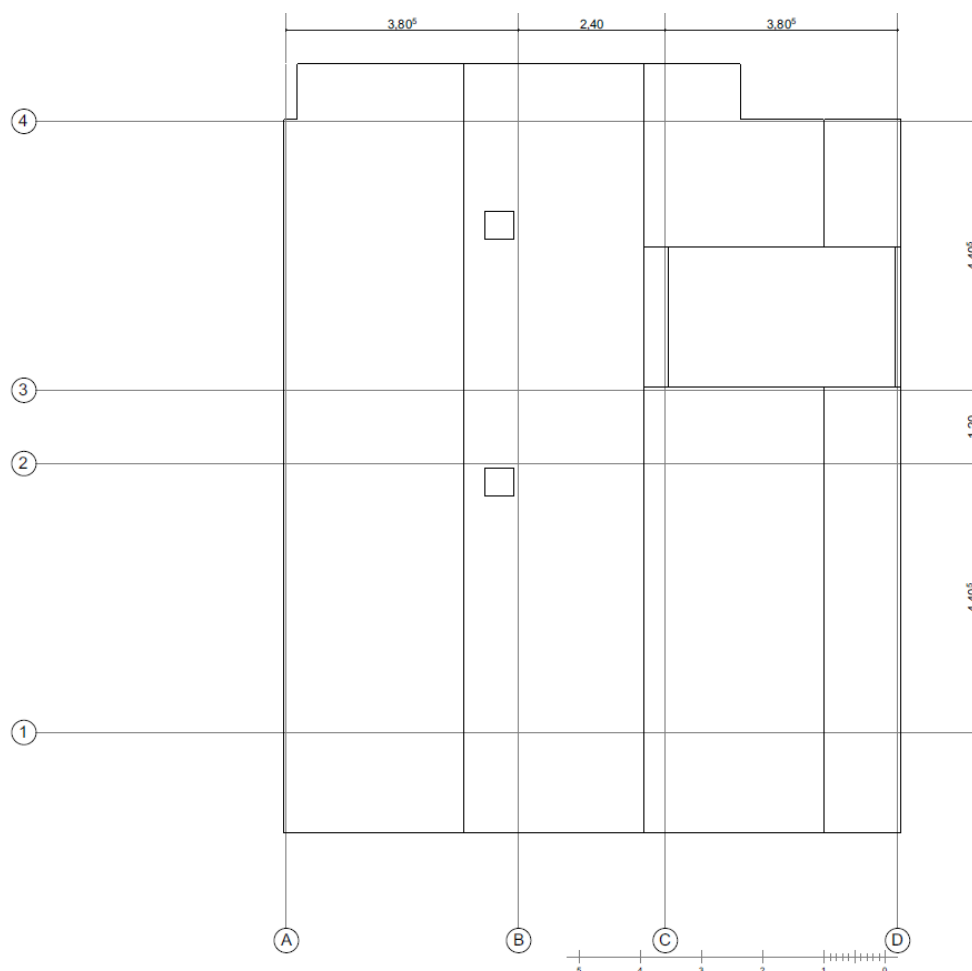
Planta da estrutura do pavimento do piso 1.
